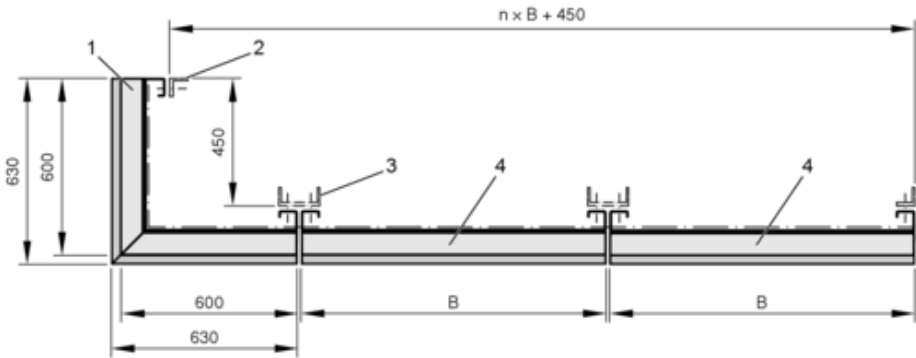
Fassadeneinbau auf bauseitiger Unterkonstruktion
